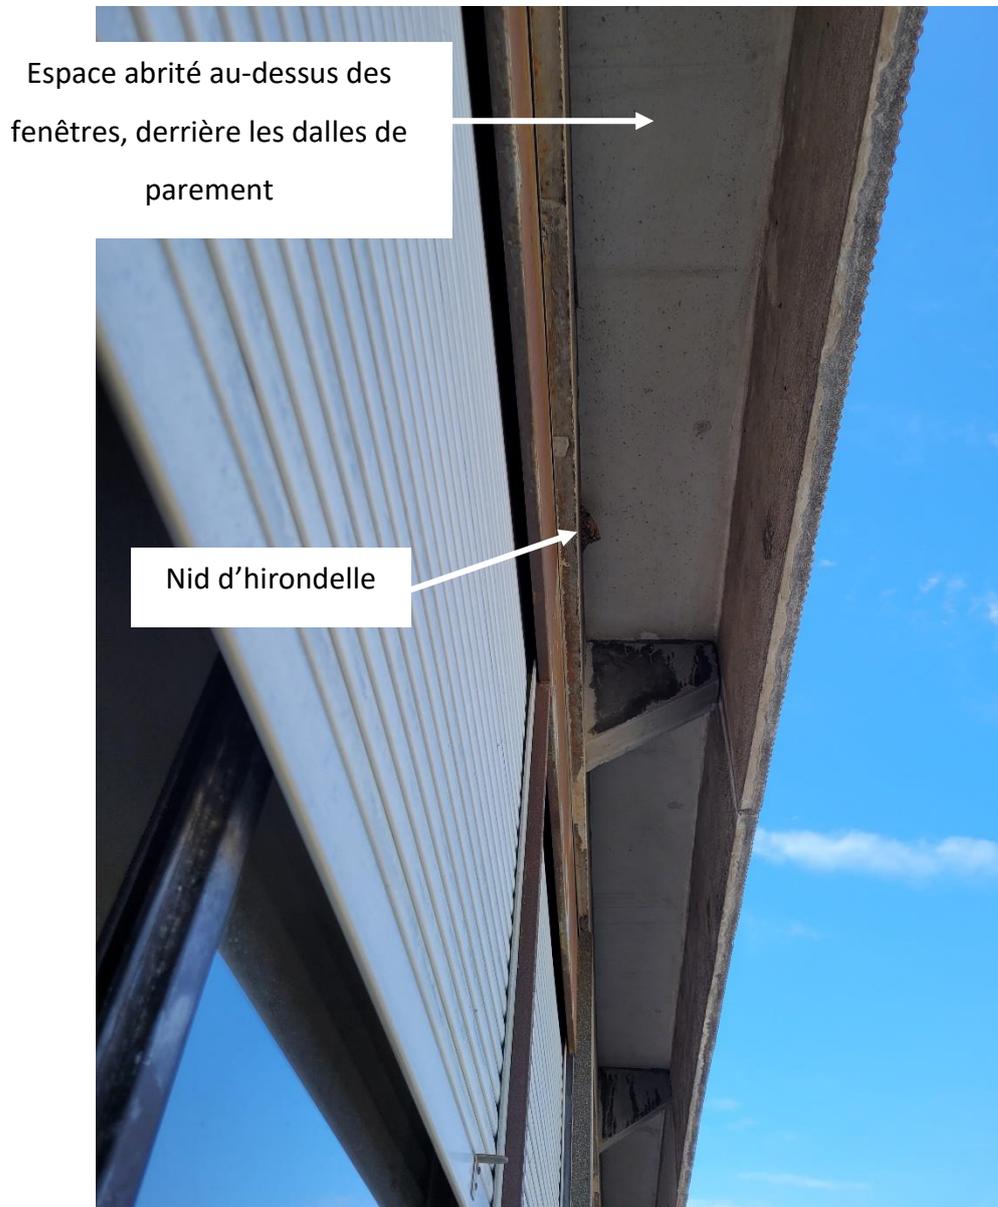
Localisation de l'espace abrité créé par les dalles de parement et nid d'hirondelle, sur la façade nord-ouest
